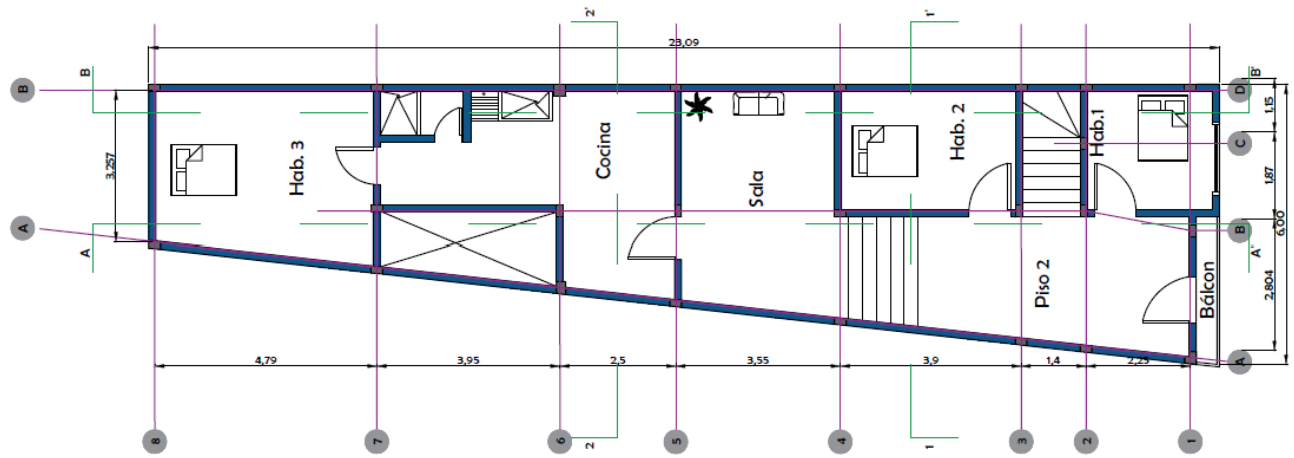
Plano en planta de segundo piso de las lesiones principales. Fuente: Autores.
